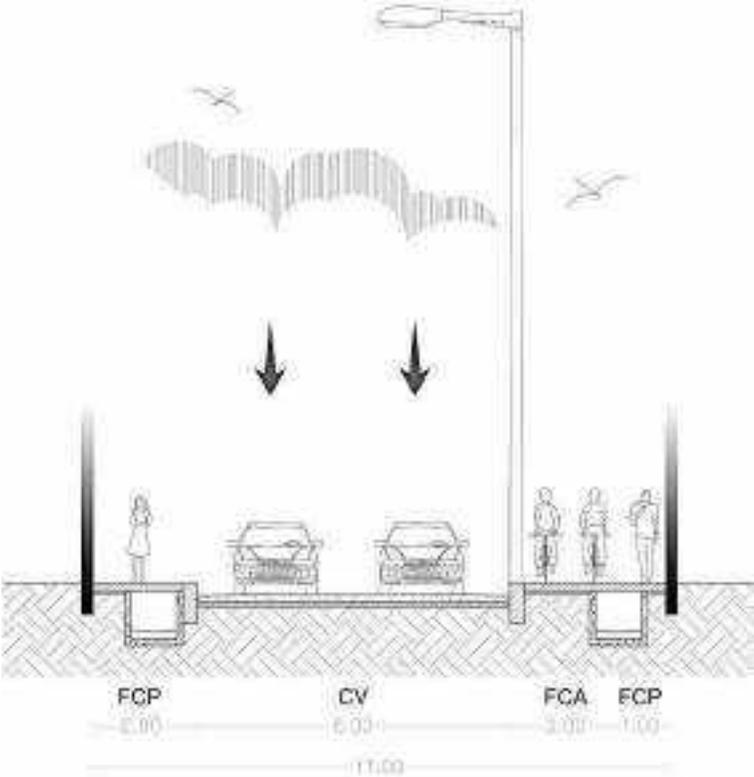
Perfil Vial Deprimido Paralelo a la Avenida El Dorado
